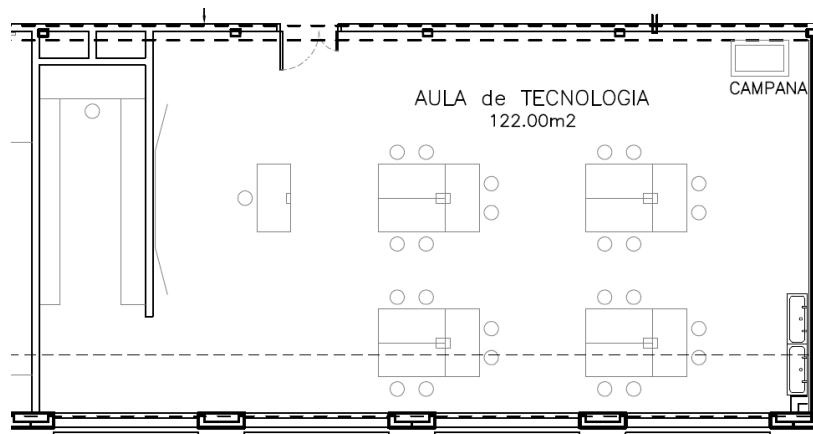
Planta del aula de tecnología. Fuente: Planos memoria proyecto.
